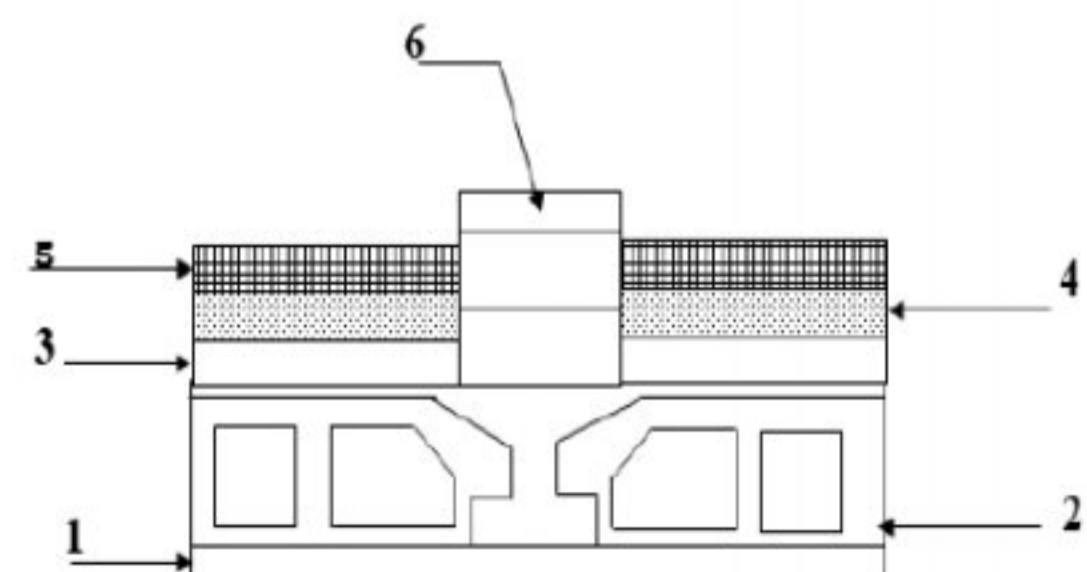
coupe transversale dans Le Plancher étage courant.
